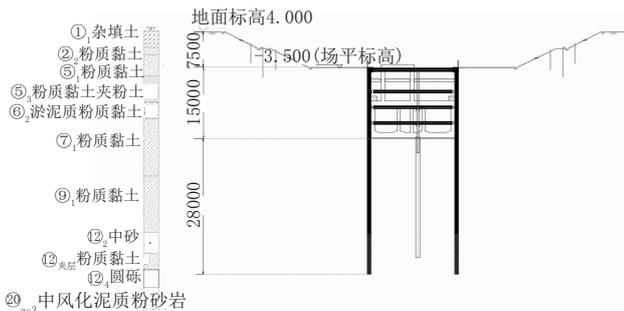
正线段基坑 B、C 区围护剖面图(单位:mm)
